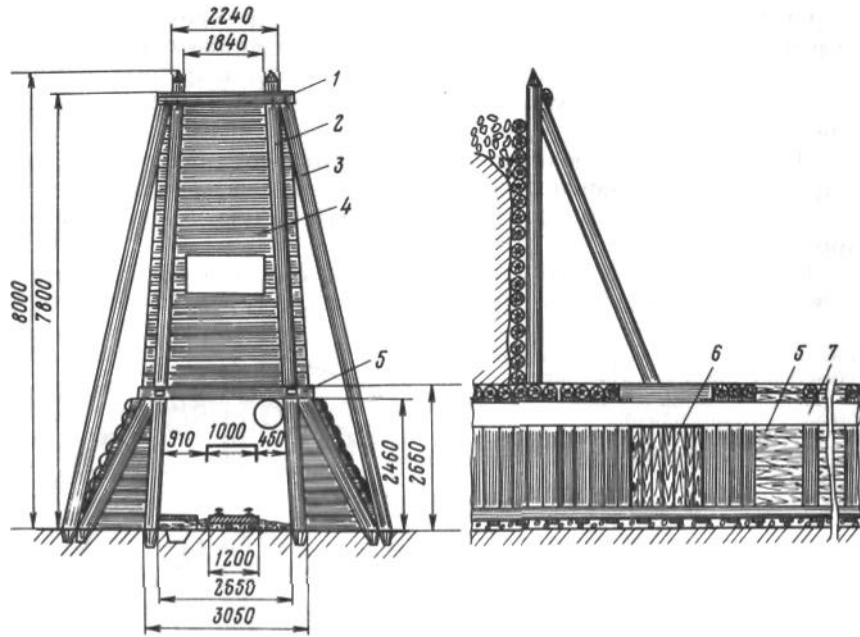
Схема крепления порталной рамы штольни: 1 – стяжка; 2 – стойка; 3 – укосина; 4 – затяжка; 5 – стяжка; 6 – галерея; 7 – вентиляционная труба
